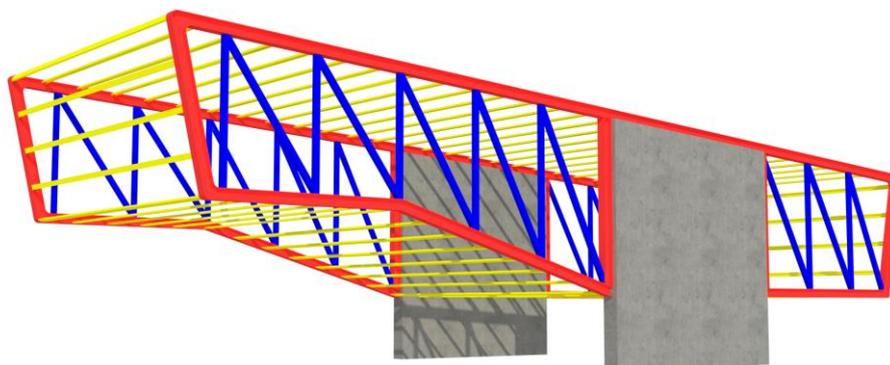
Desmontaje de Estructura de Auditorio del CEAR Loja
